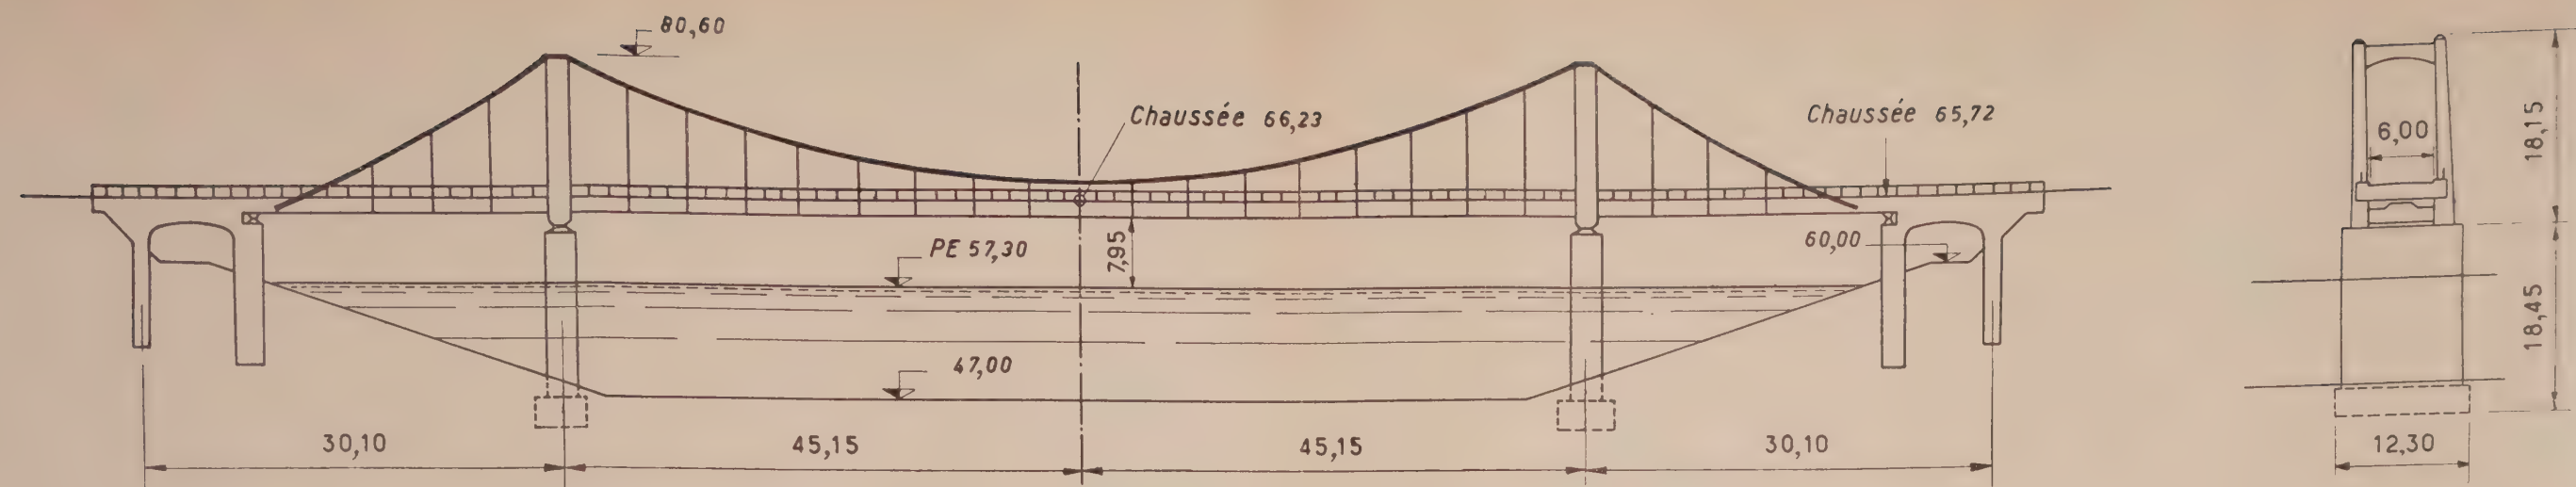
Pont du C. D. 59. Élévation et coupe transversale.
